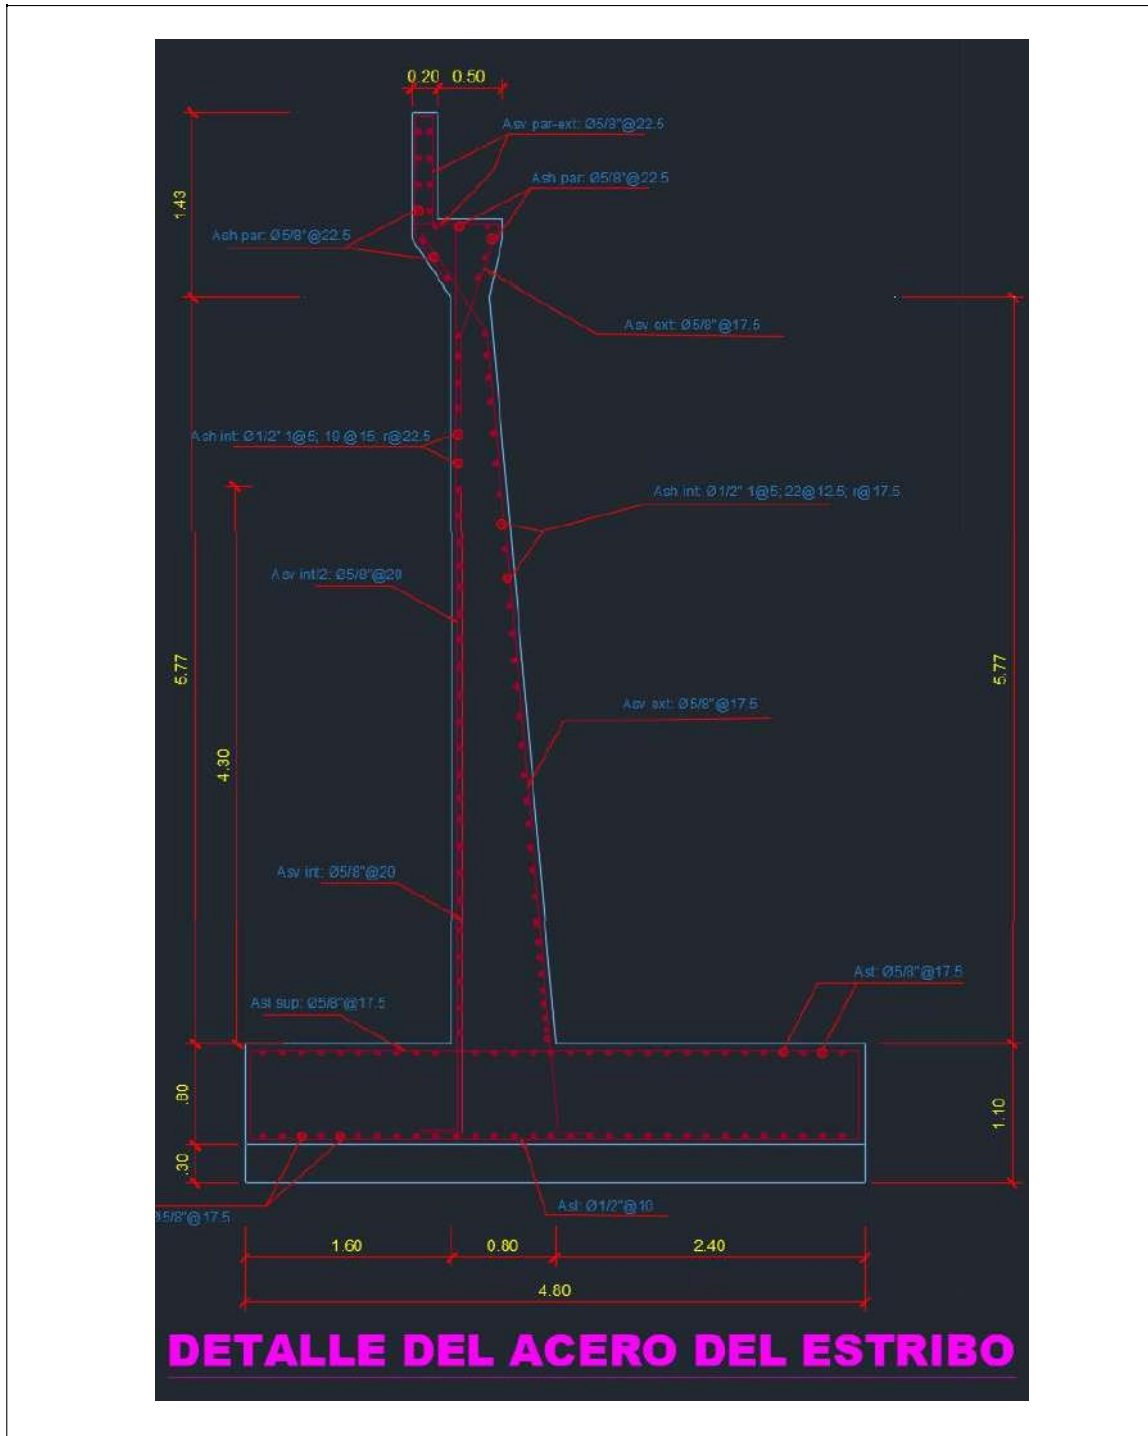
Detalle de dimensiones de elementos y acero del estribo
